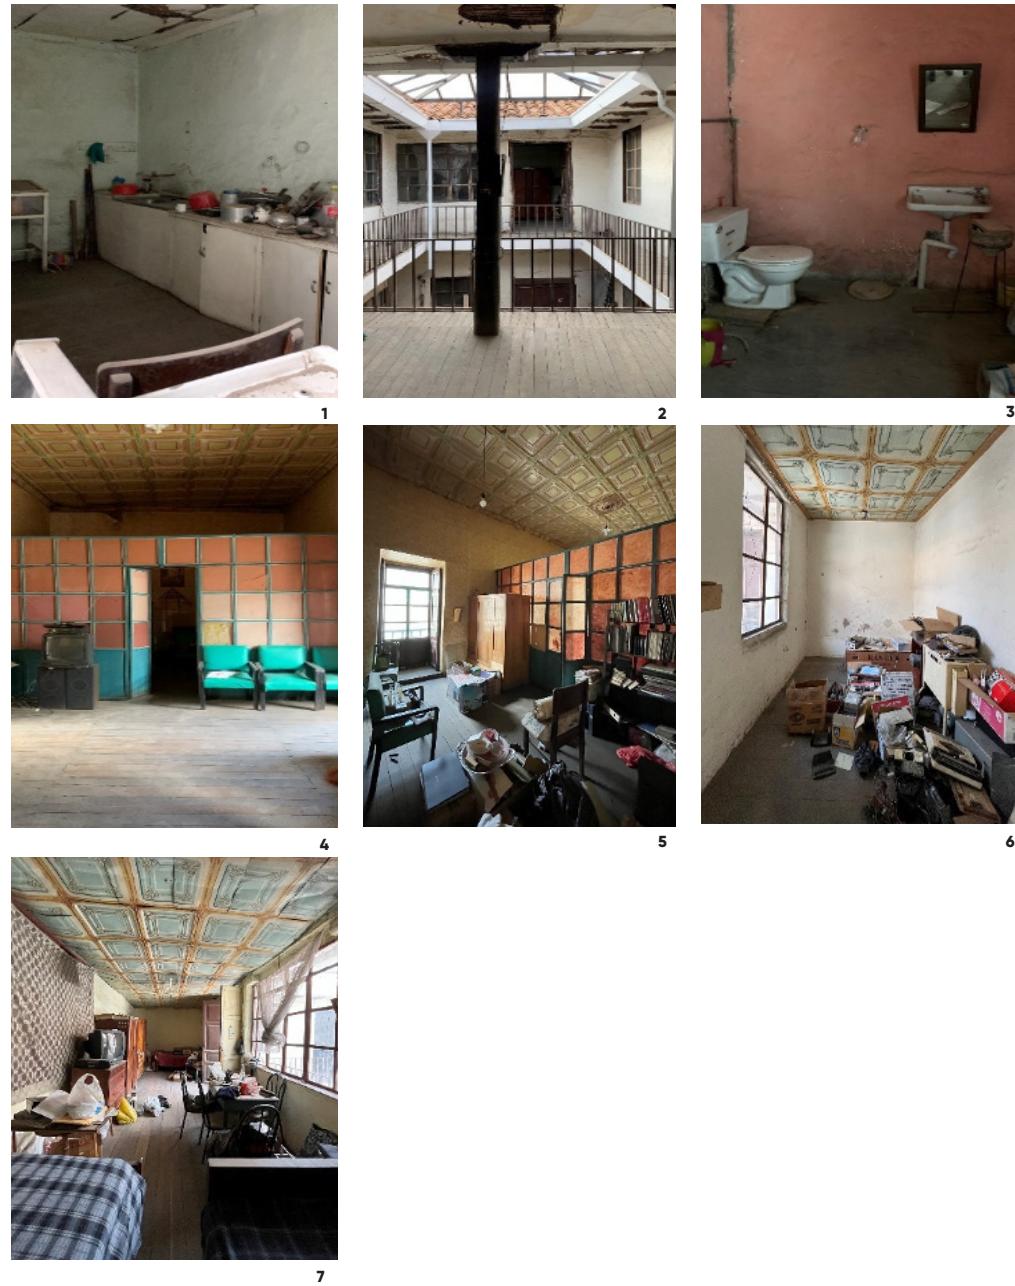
Ilustración. Planta Alta de la Vivienda. Realizada por el autor
